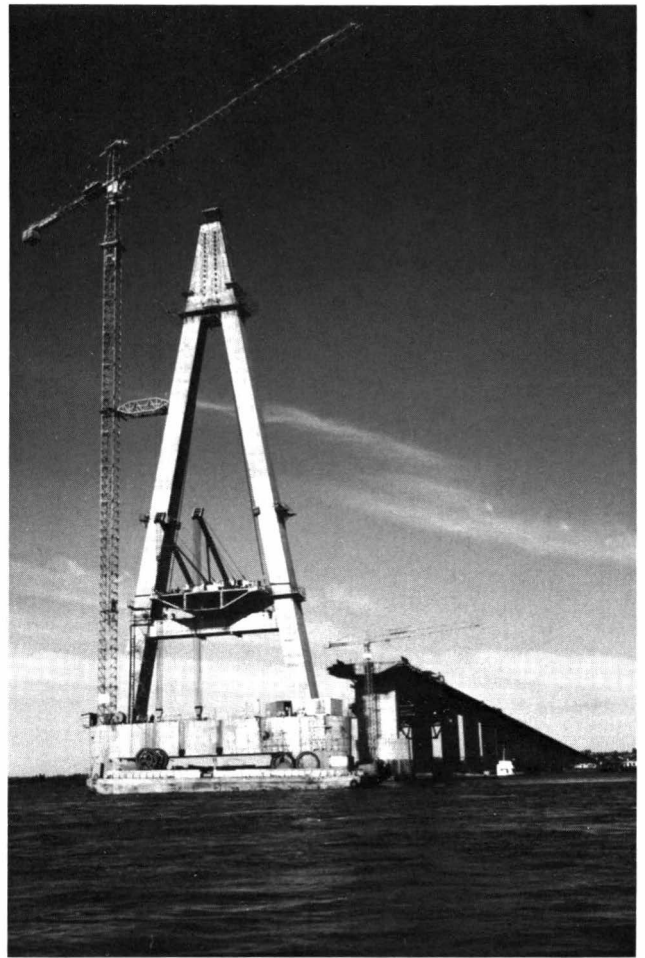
Erstes Hohlkastenelement im Pylonbereich erstellt – Premier élément de la poutre-caisson, construit directement sur le pylône – First hollow-box girder made up in the area of the pylon
